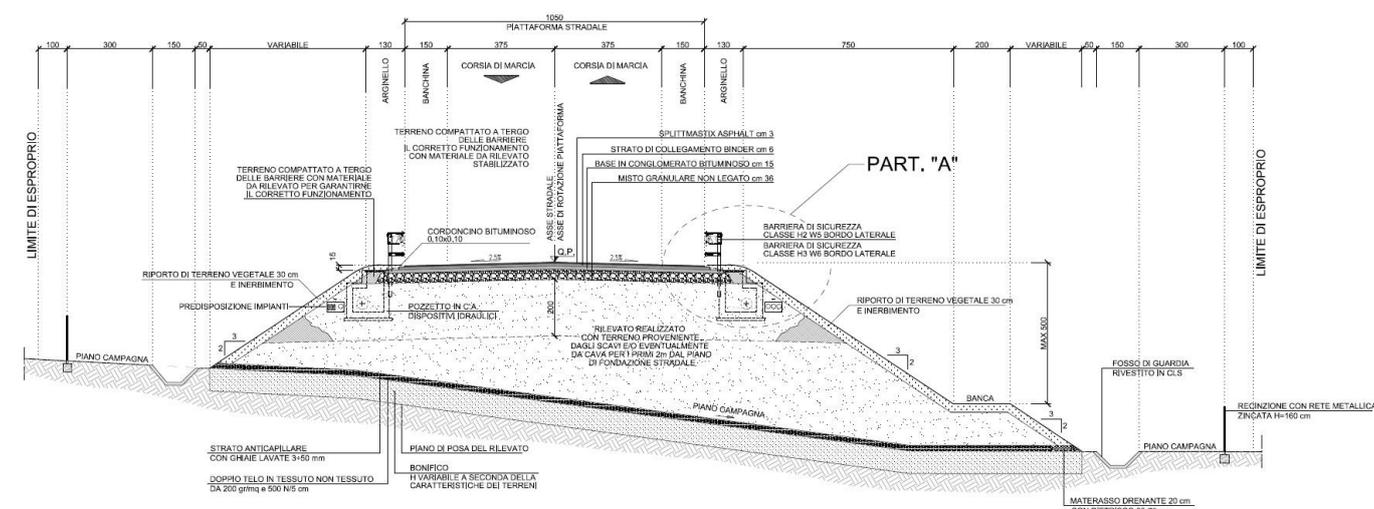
SEZIONE TIPO IN RILEVATO
